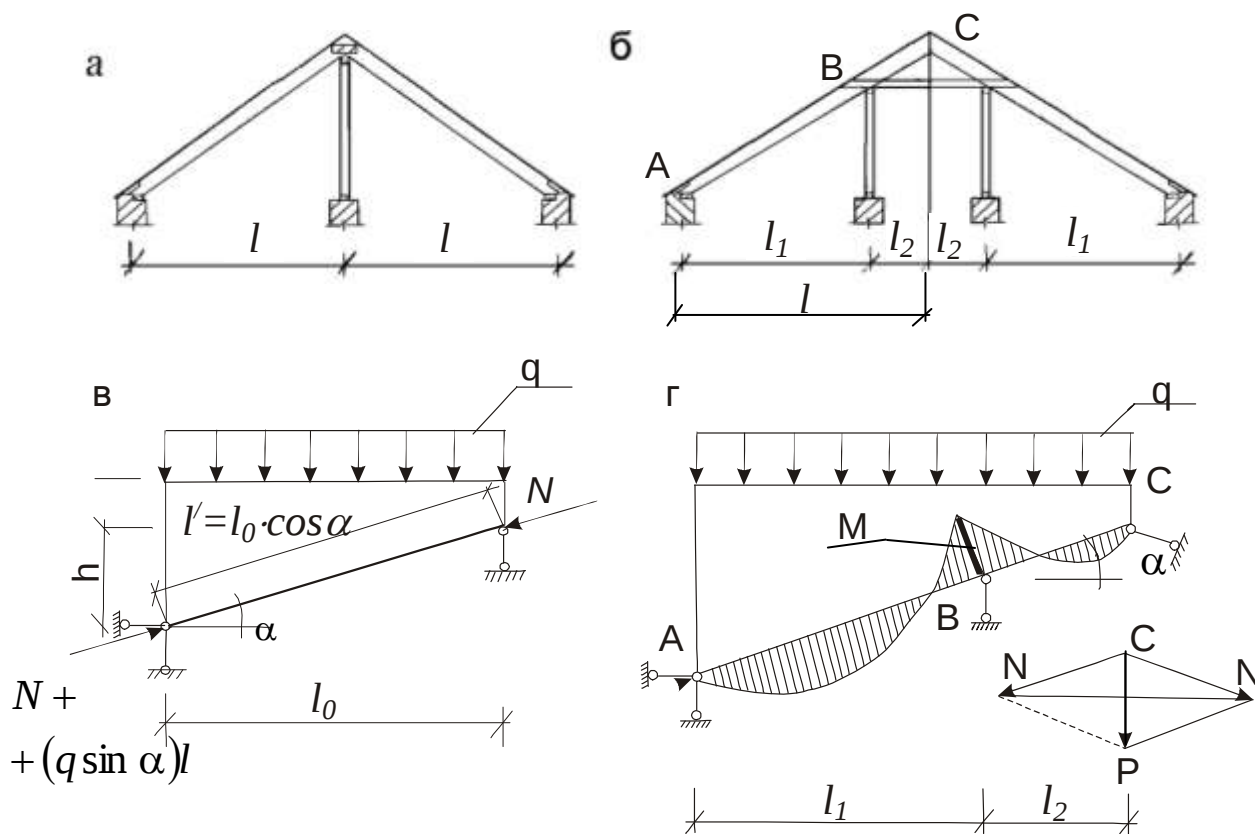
Наслонные стропила: а–однопролетные; б–двухпролетные; в–расчетная схема однопролетных стропил; г–расчетная схема двухпролетных стропил
